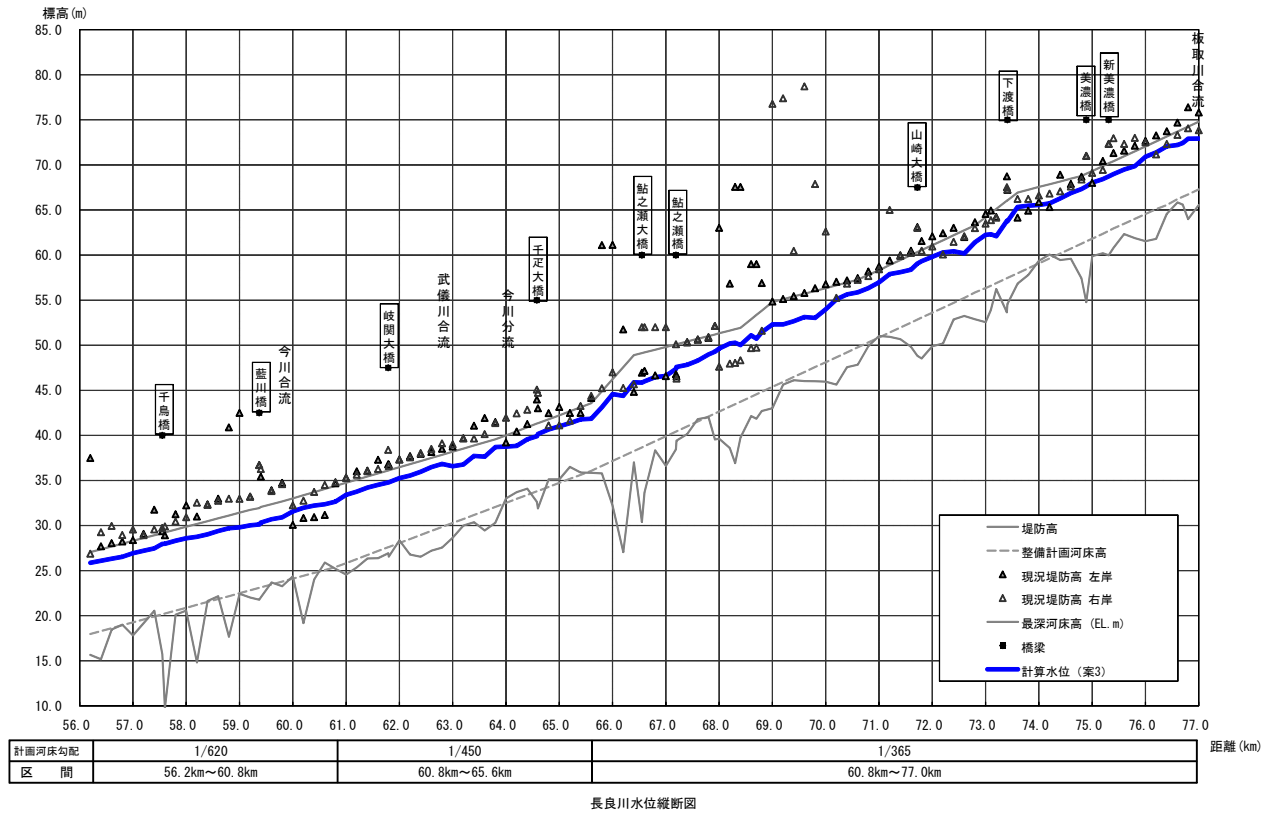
河道改修+遊水地案 縦断面図(56km~77km)
